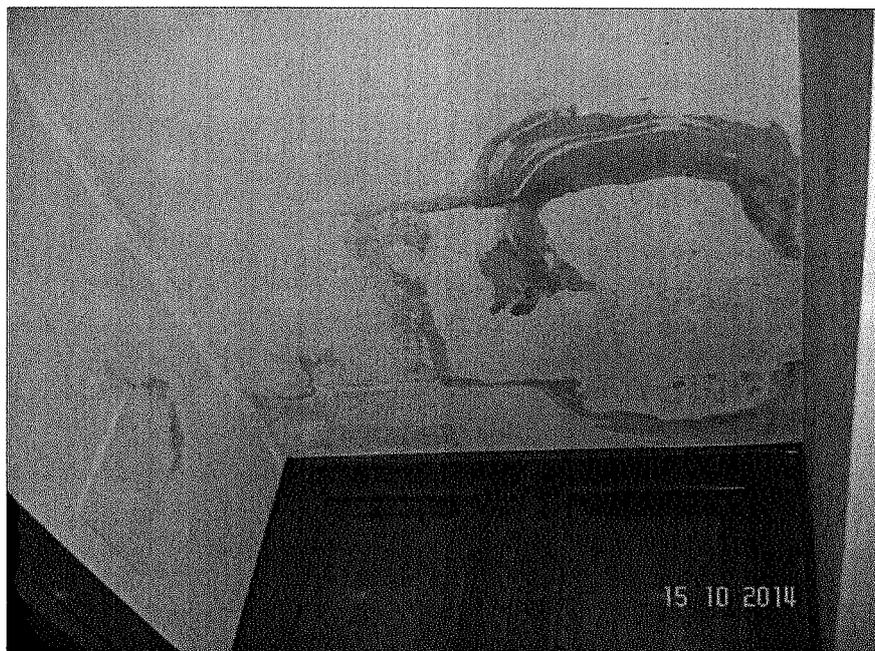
Disimpegno – Macchie d'acqua , esfoliazioni e distacchi della pittura murale e dell'intonaco dovute a ,ormai risolti, fenomeni infiltrativi;
